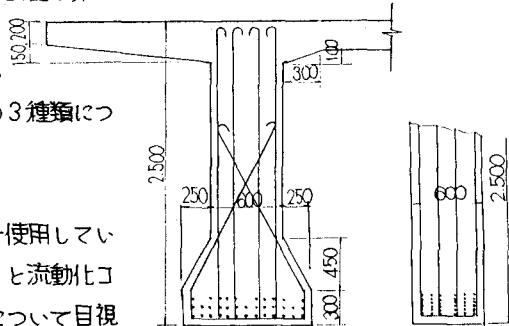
現行の配筋 図-2 重ね配筋とした時の配筋
